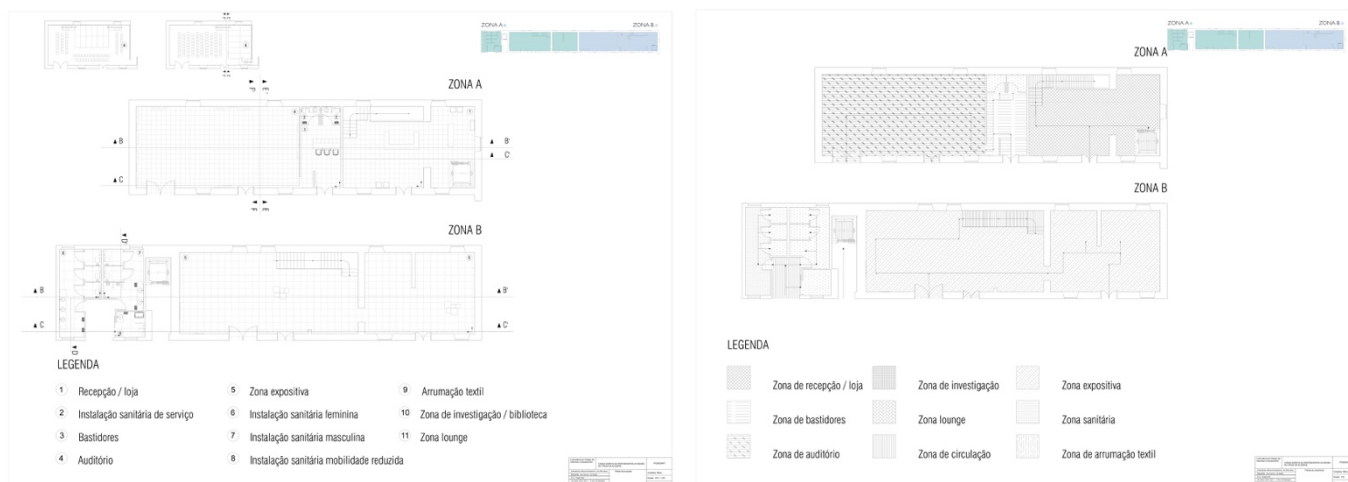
Planta de proposta do piso 0 e planta de zonamentos do piso 0, respetivamente da esquerda para a direita. Elaborado por: Vera Sancho
